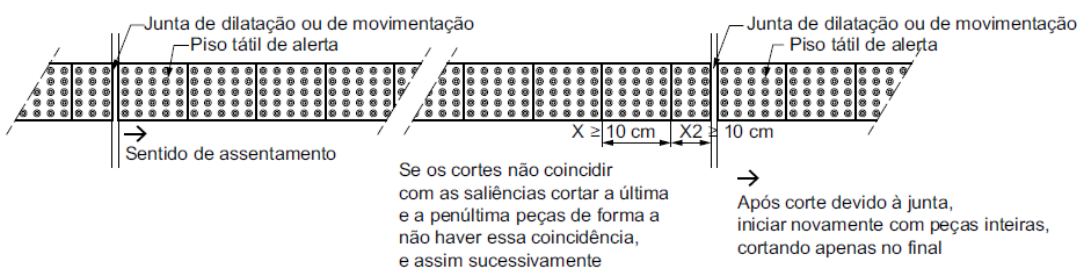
Cortes e emendas de piso tátil de alerta – corte de duas peças Fonte: ABNT NBR 16537 – 2016
